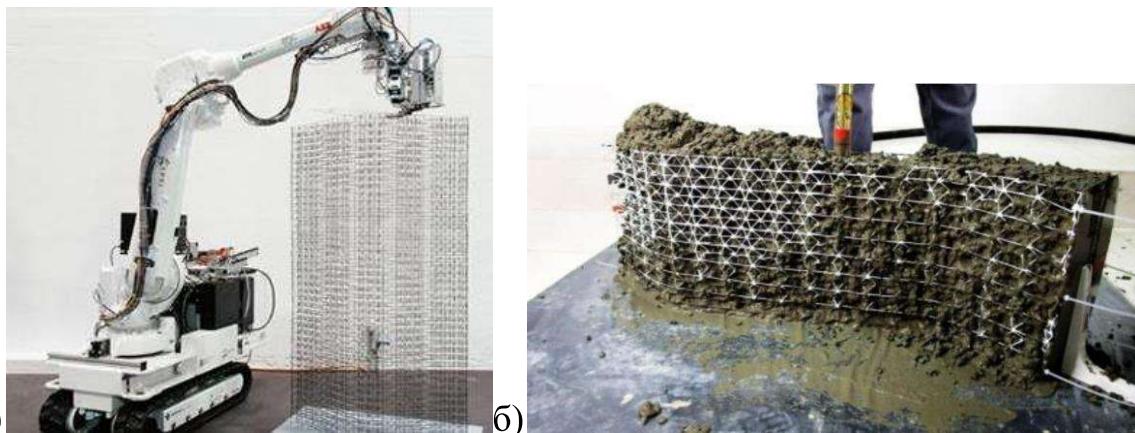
Проект Mesh Mould: а – создание стального арматурного каркаса [2]; б – процесс укладки бетонной смеси [3]
